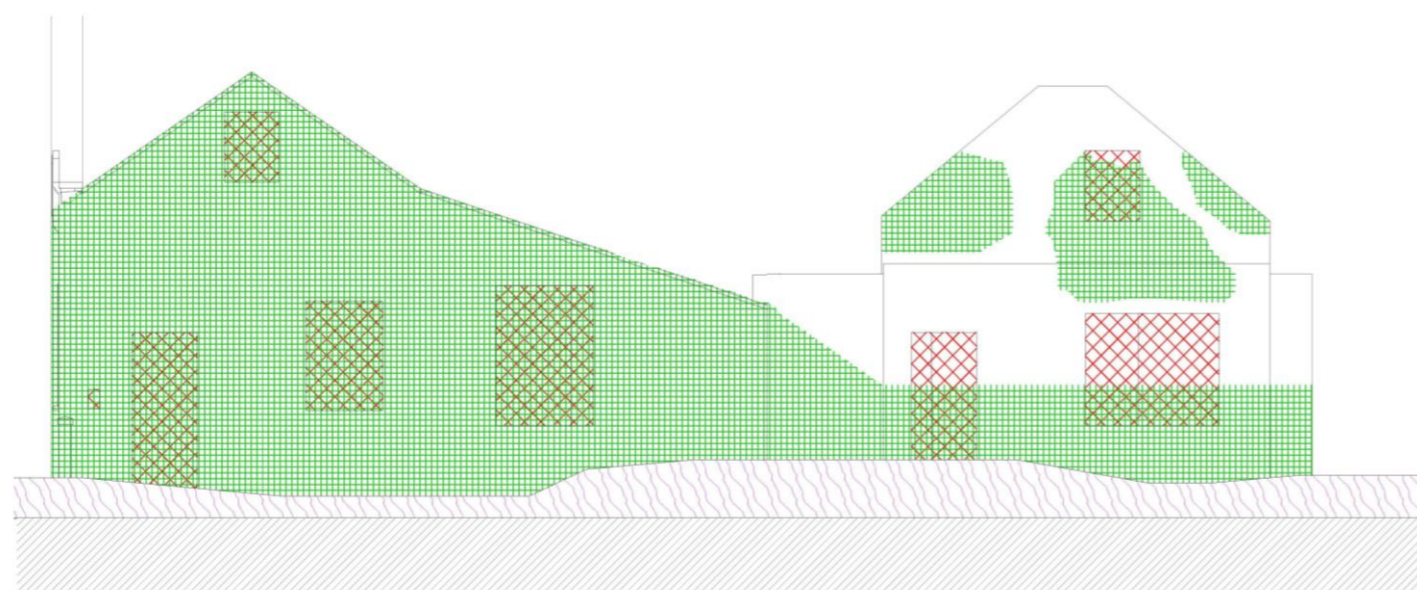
Mapeamento de danos – Fachada travessa Jorge Baggenstoss.
